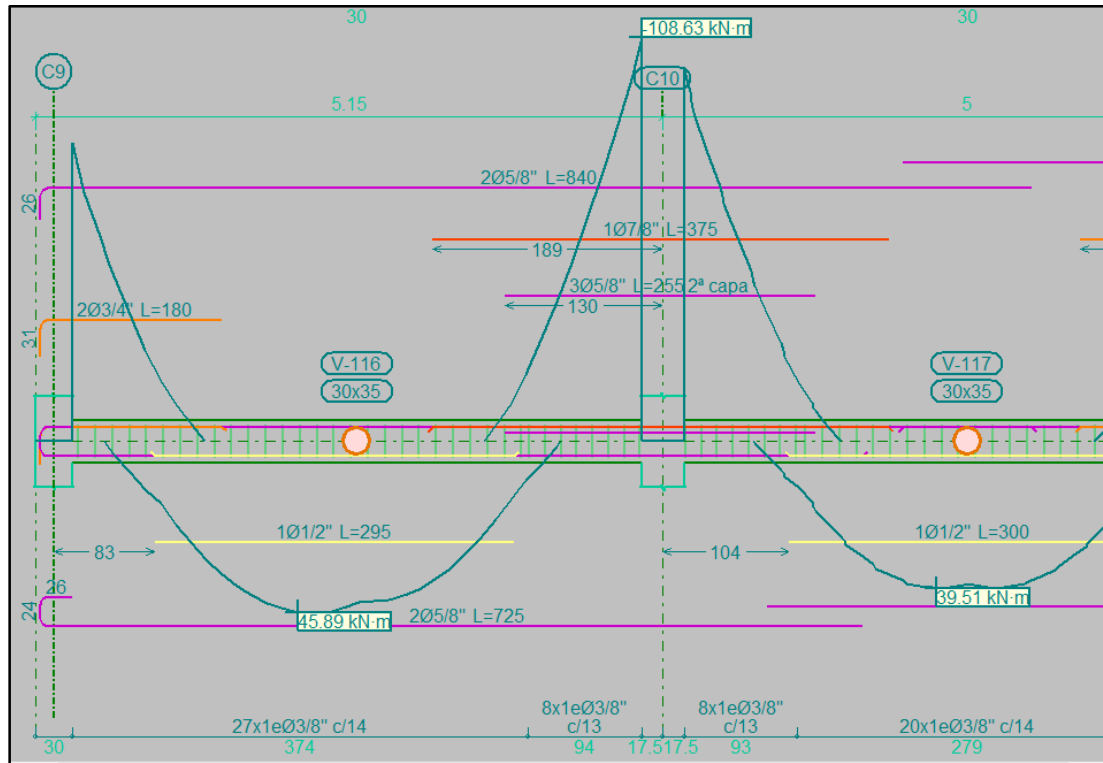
Despiece de viga intermedia con detallado correspondiente a estructuras DMO
